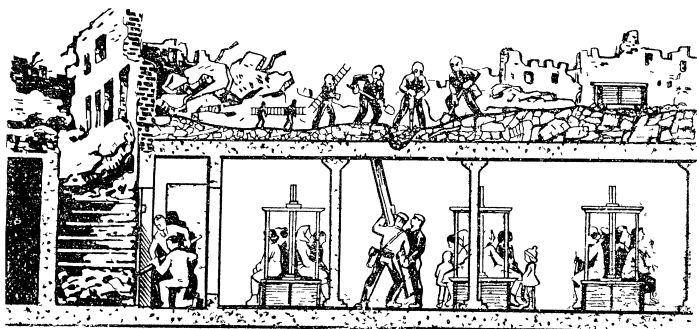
Вскрытие убежища путем пробивки отверстия в перекрытии
